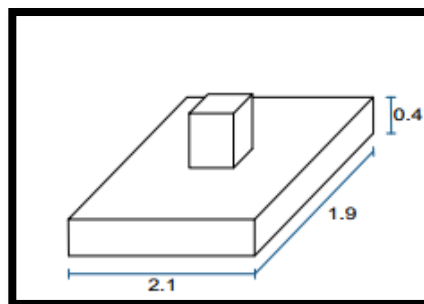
Dimensiones de zapatas centrales. Fuente: Elaboración propia.
